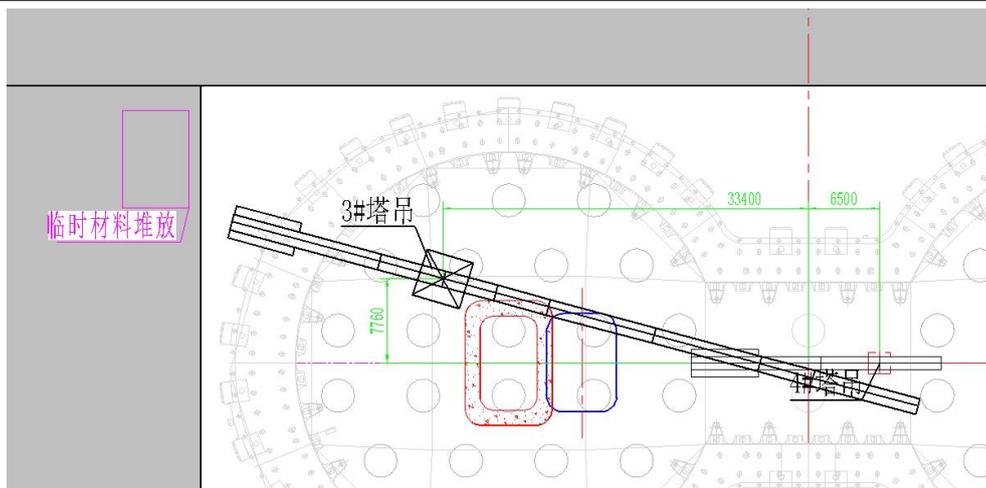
4#塔吊平衡臂吊装平面示意图
